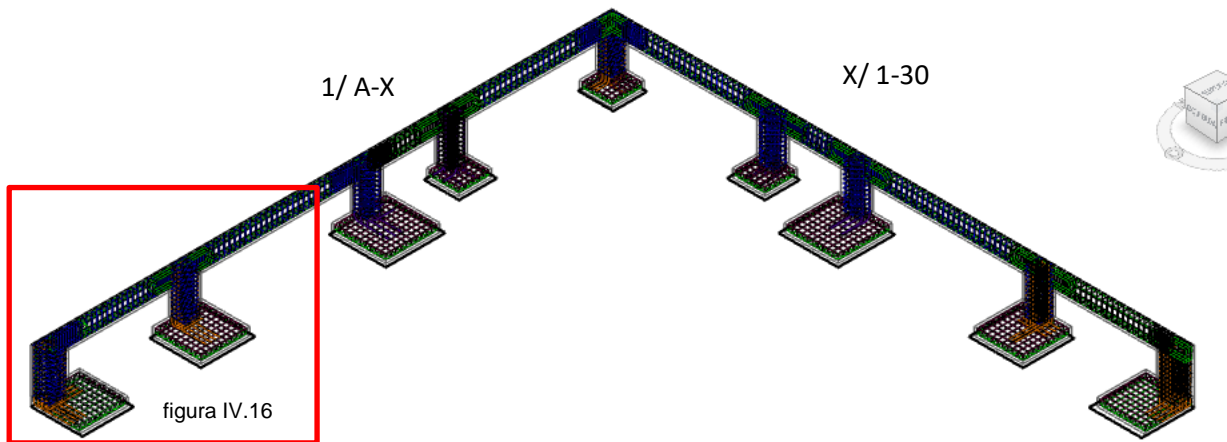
Detalle estructural contratrabe Ct-1 (Autoría propia).
